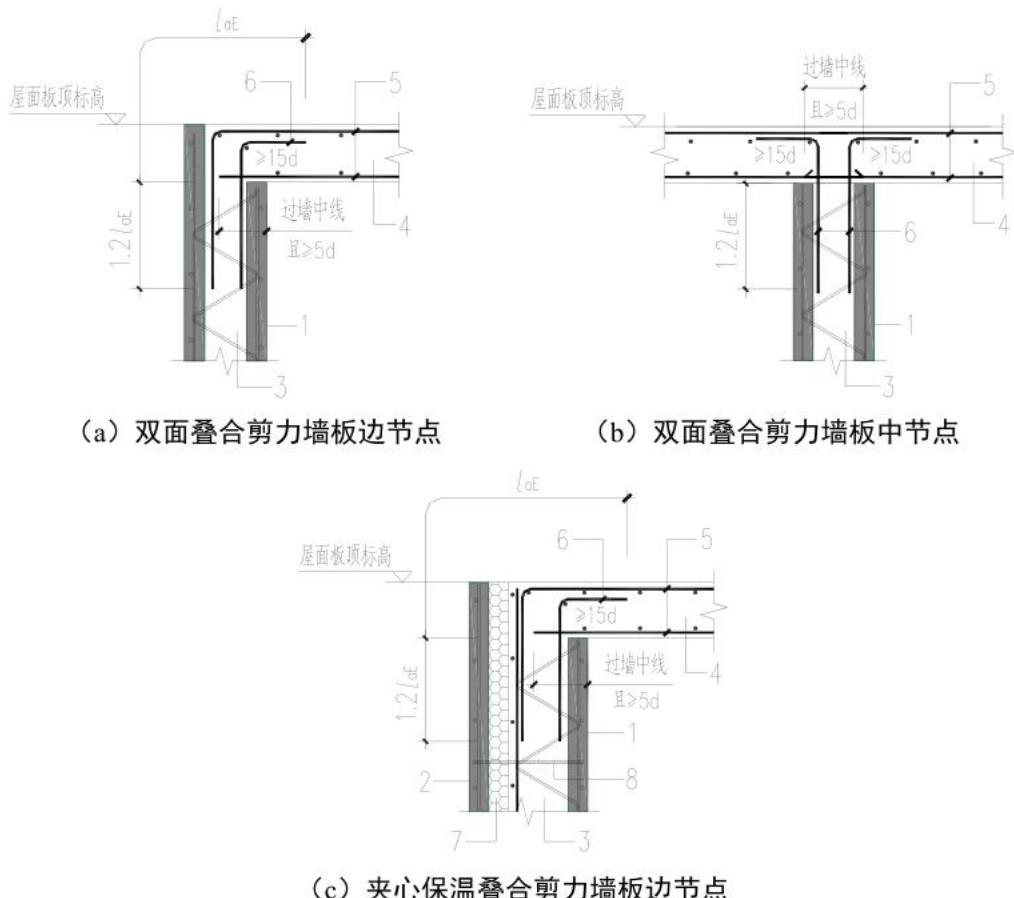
现浇屋面板与叠合剪力墙相连支座构造示意
